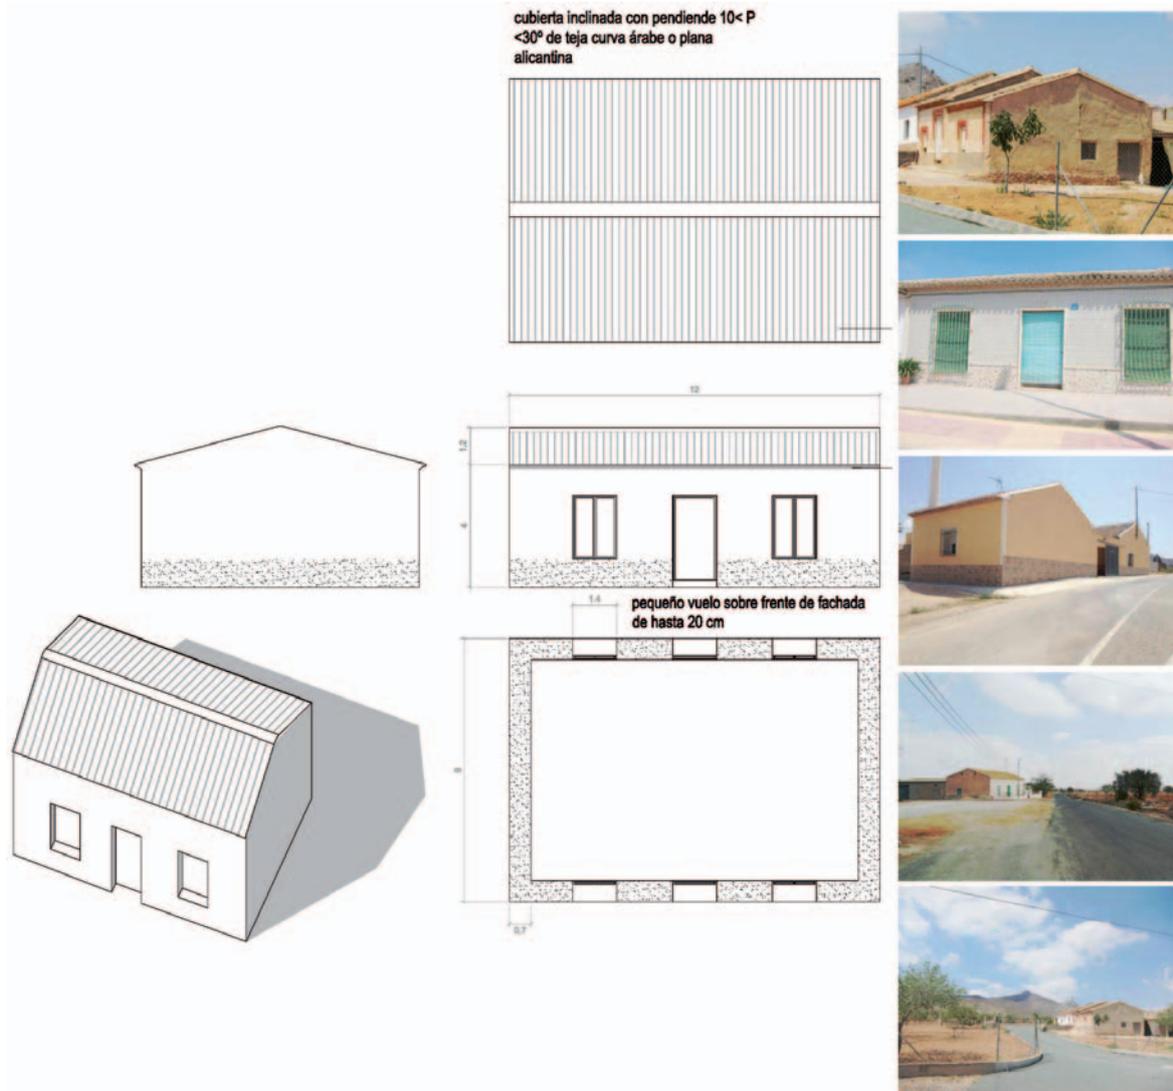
La vivienda tradicional: vivienda con cubierta a dos aguas
